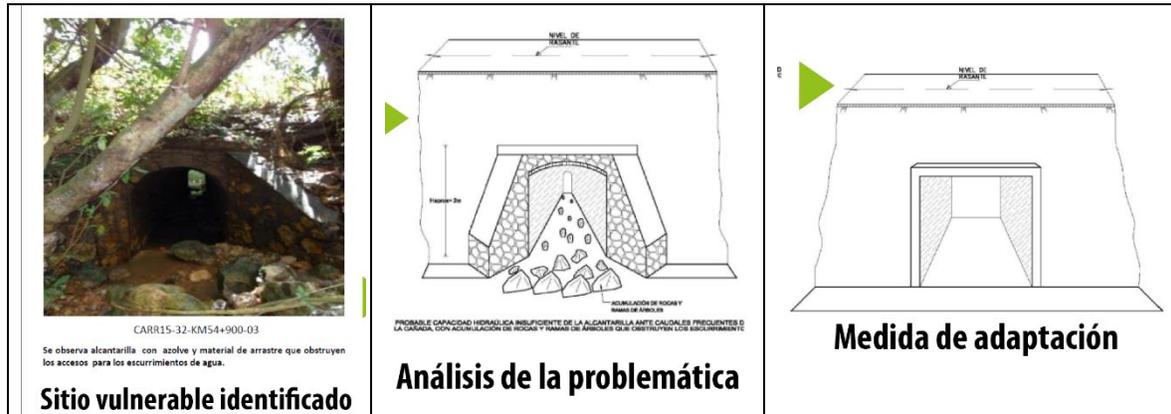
Ejemplo de medida de adaptación para alcantarillas
